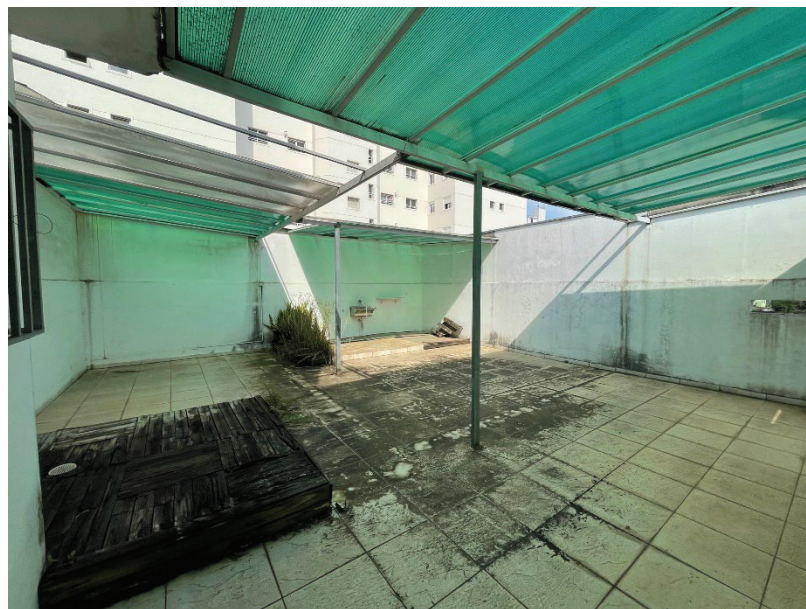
Varanda e área de serviço – Apartamento 31 – 4º Pavimento – Avaliando
